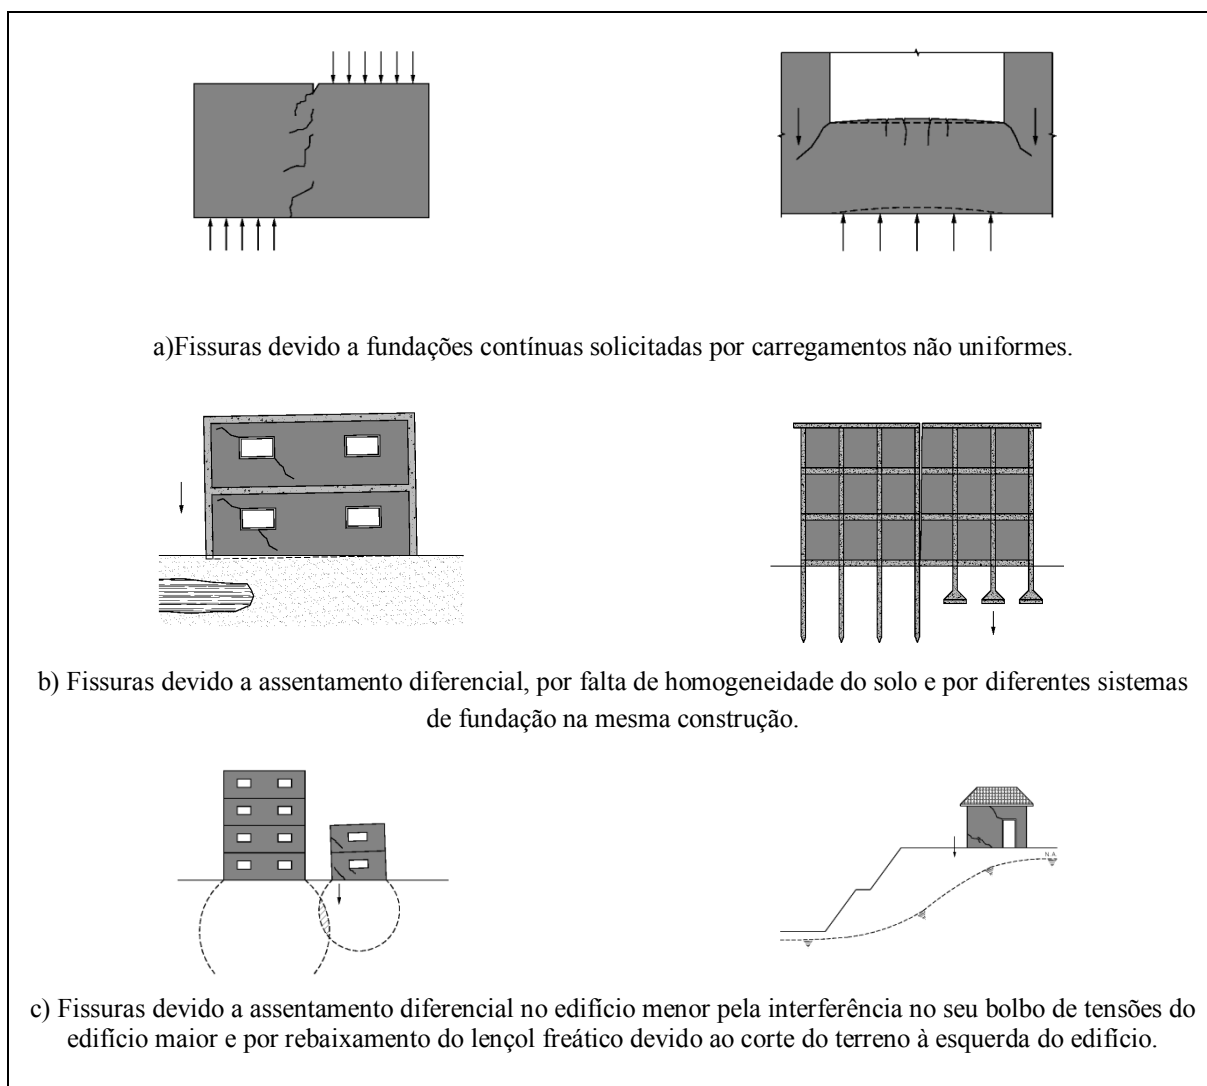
Fissuras devido a movimentos da fundação (PEREIRA, 2005)
